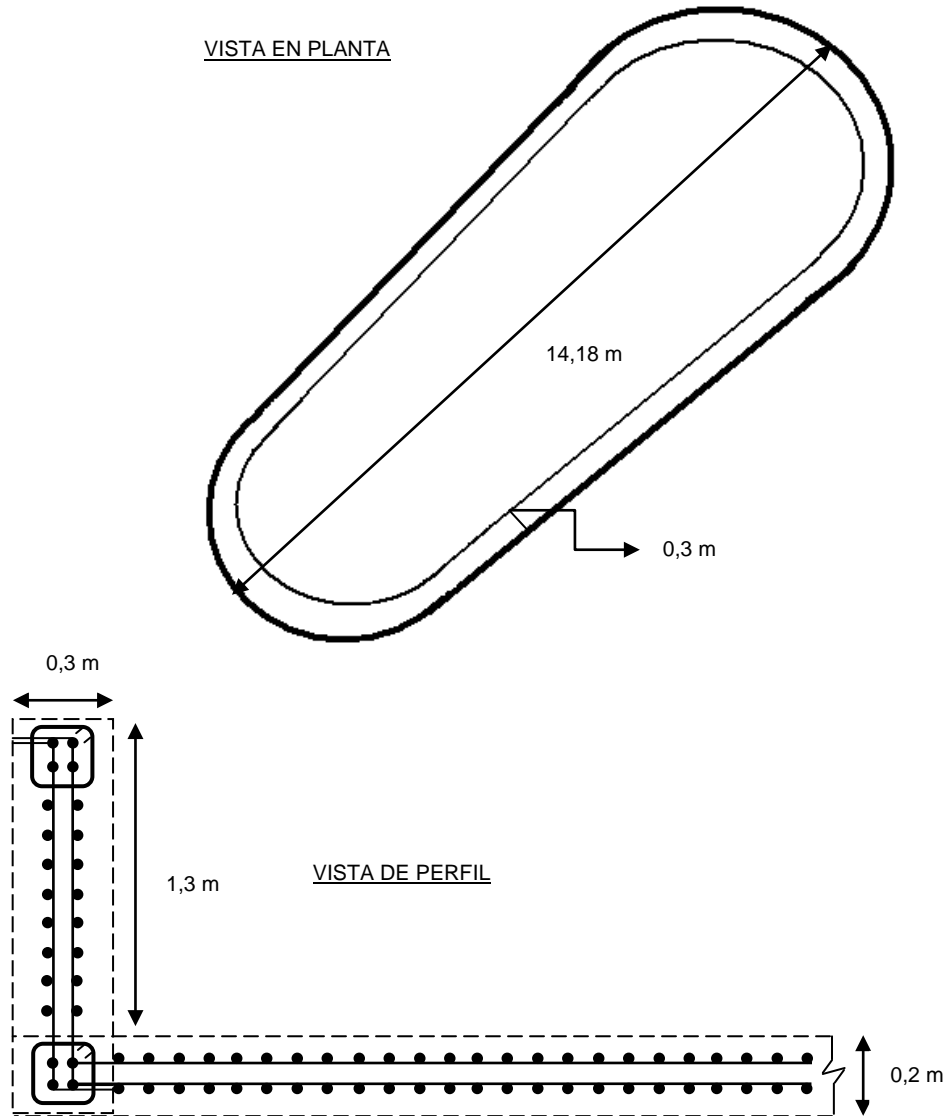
y 6, Esquema de viga superior e inferior de la piscina. Fuente Propia
